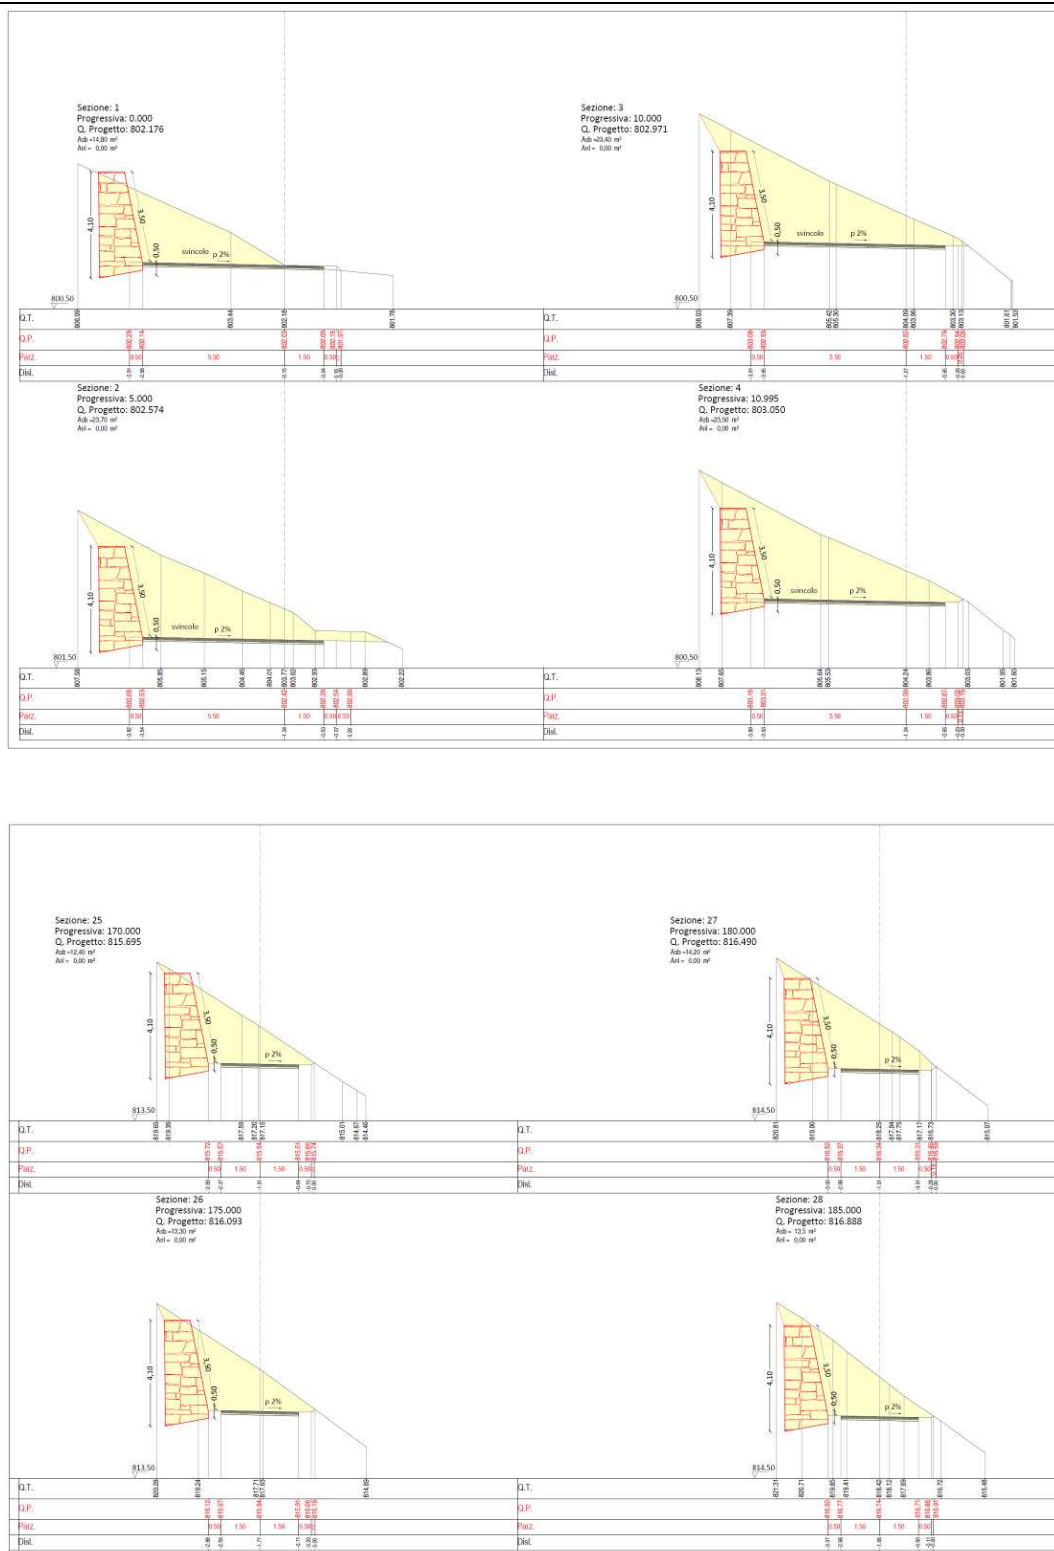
estratto sezioni di progetto più significative tratto iniziale pista in progetto
